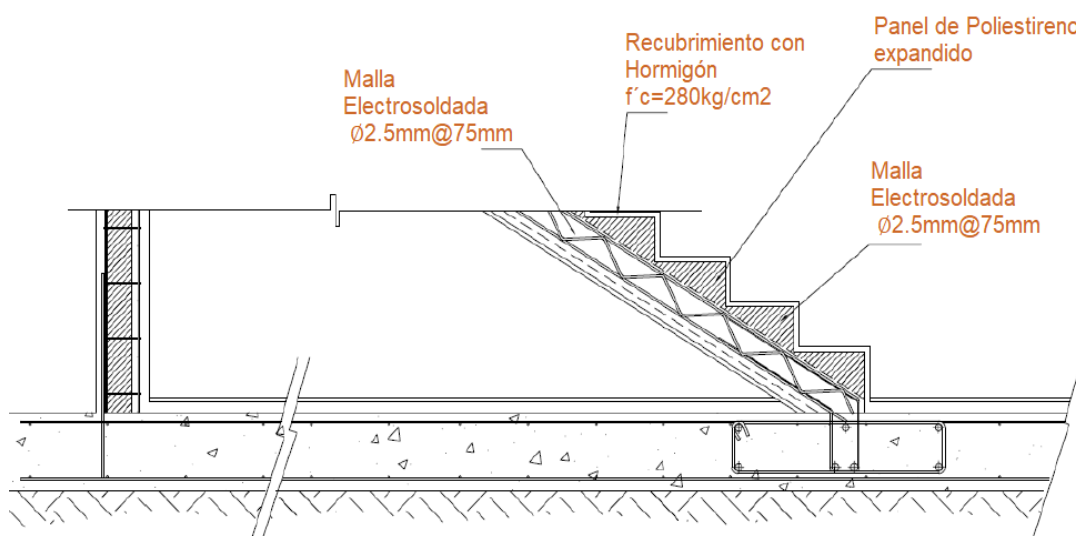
Detalle unión del panel escalera a cimiento (ELEVACIÓN)
